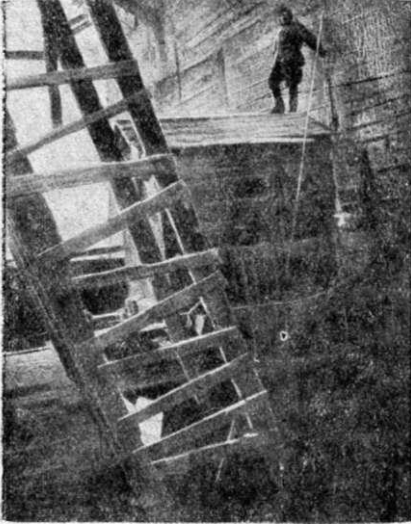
Предварительный монтаж приборов для напорного блока.
